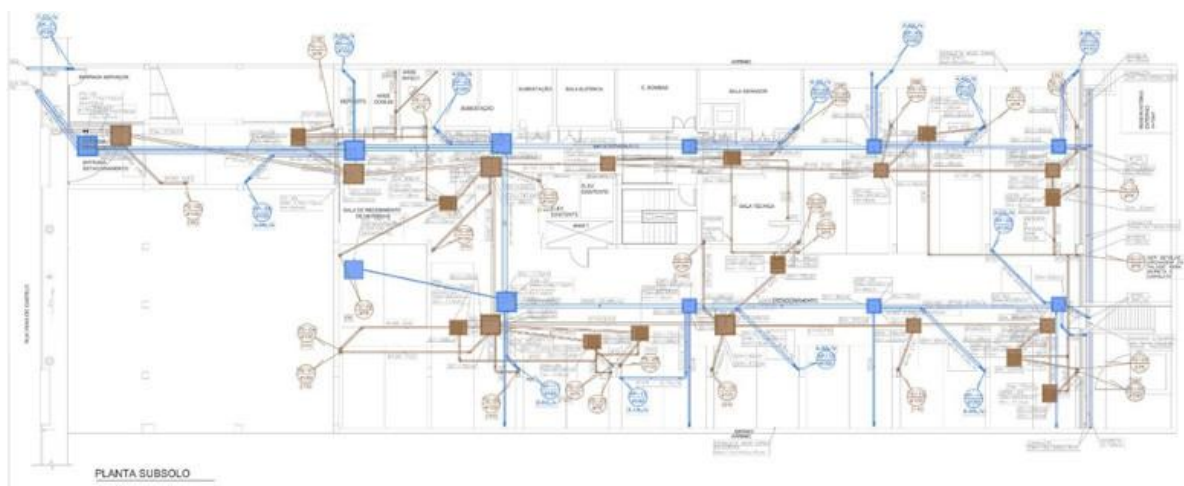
Planta Subsolo – redes de tubulações de esgoto (marrom) e drenagem (azul).
